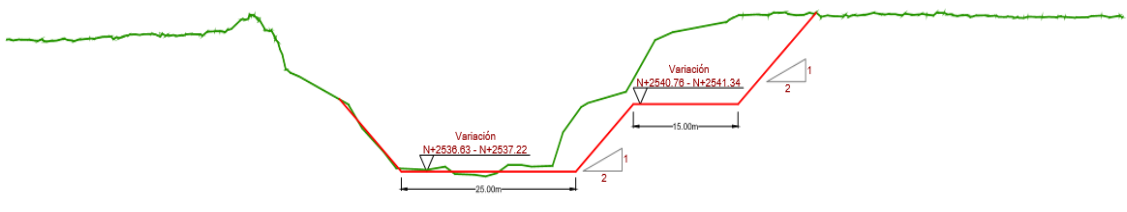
Sección típica 3 de corte transversal Aeropuerto.
